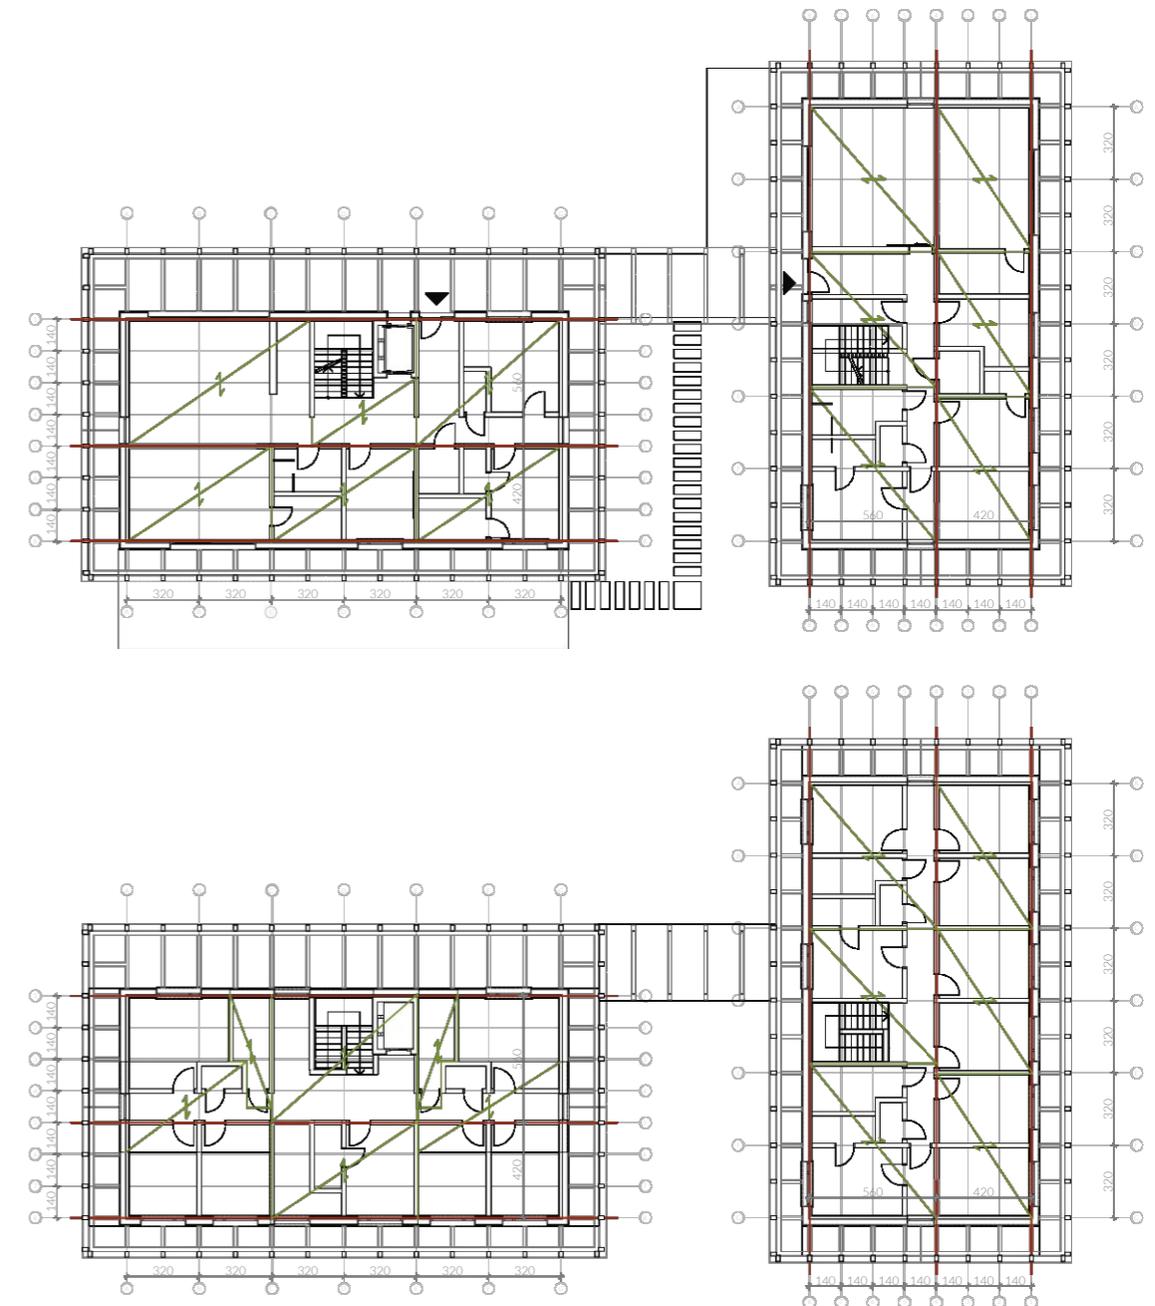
Tragwerkskonzept Grundriss Erdgeschoss
